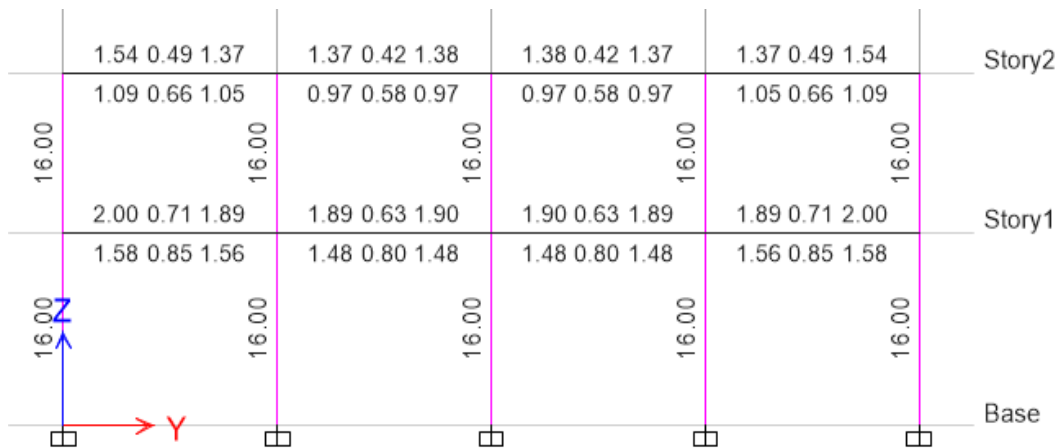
Áreas de acero longitudinal requeridas en viga y columnas, en el eje A.
